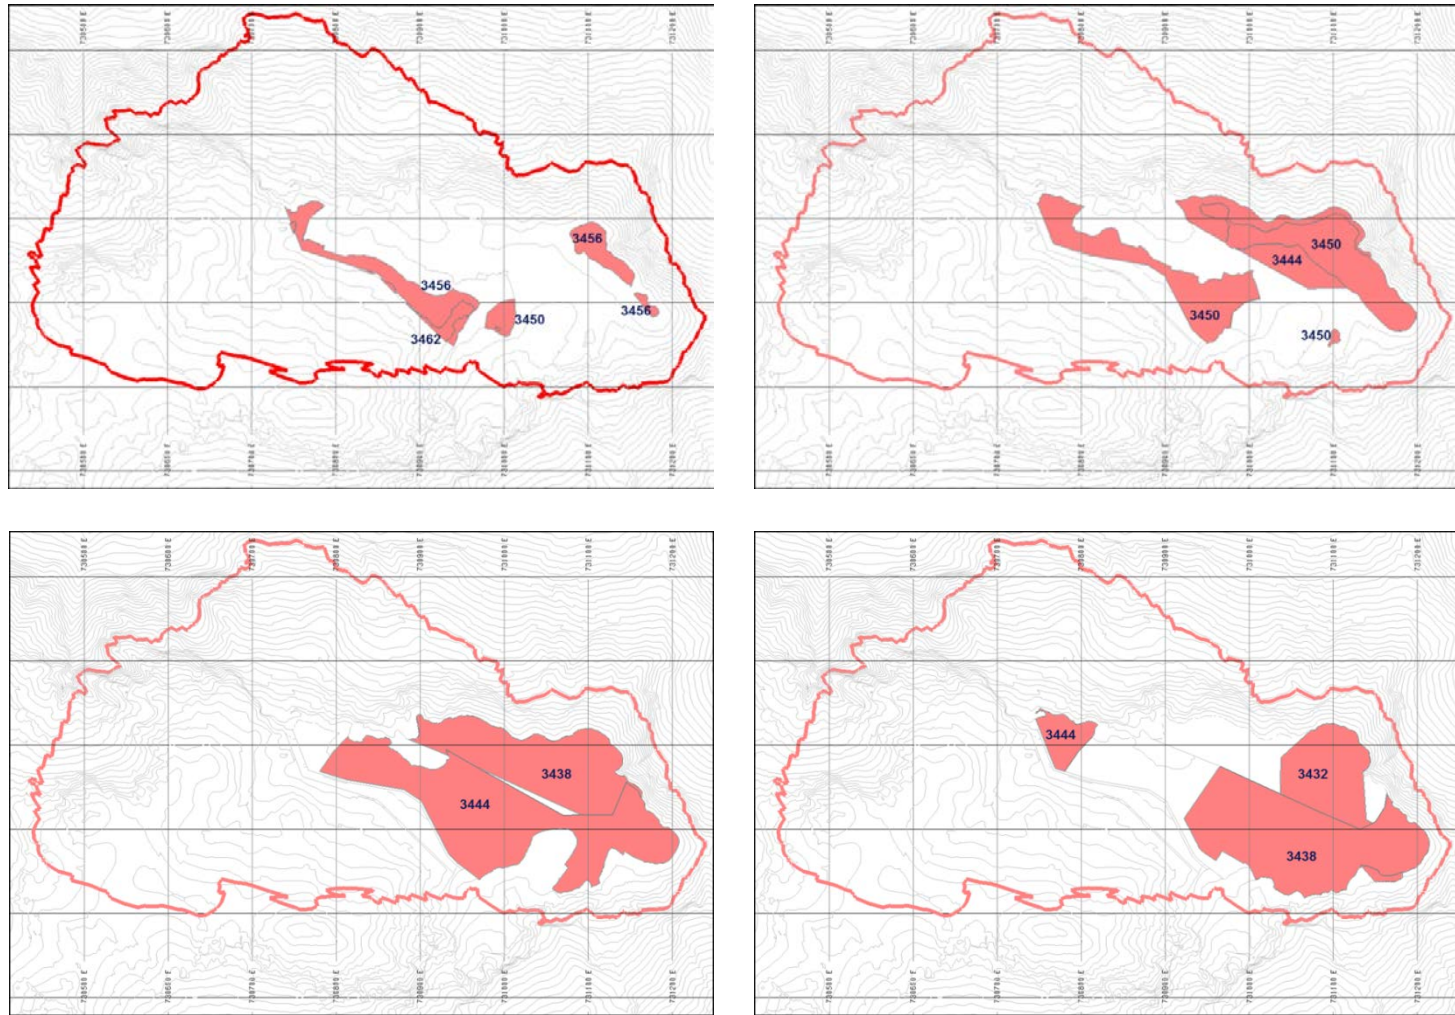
Vista tajo Pampa Verde, plan de minado fase 01 – primeros bancos.
